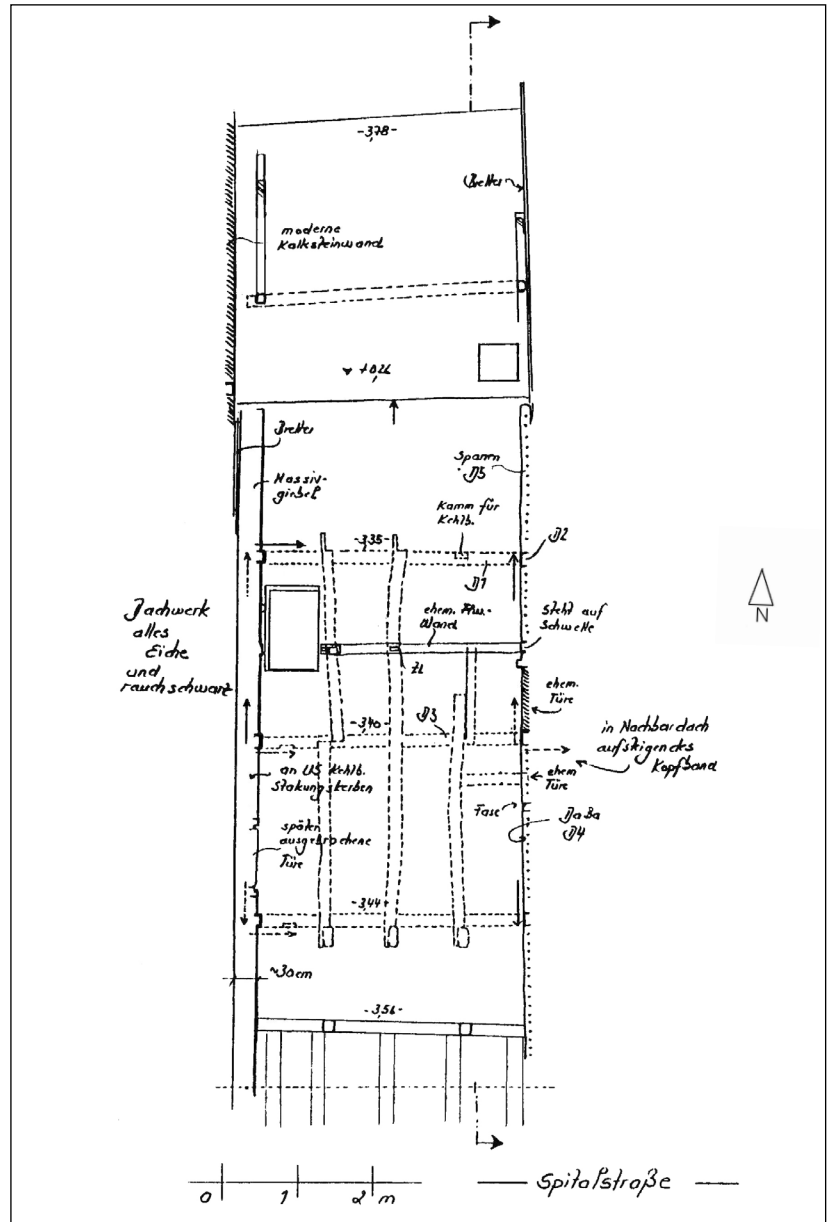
Spitalstraße 23, Grundriss 1. Dachgeschoss.
